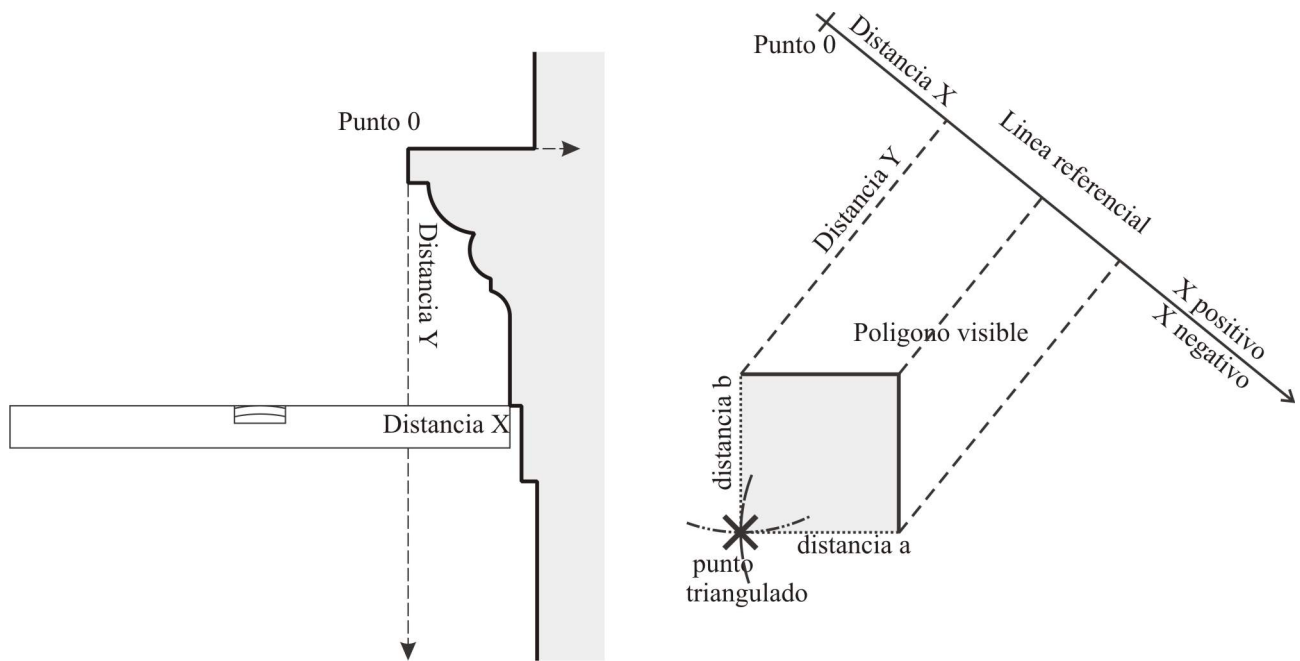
Vermessung von Schnitt (links) und Grundriss (rechts) mit Referenzlinienverfahren. Eigene Zeichnung, 2005.
